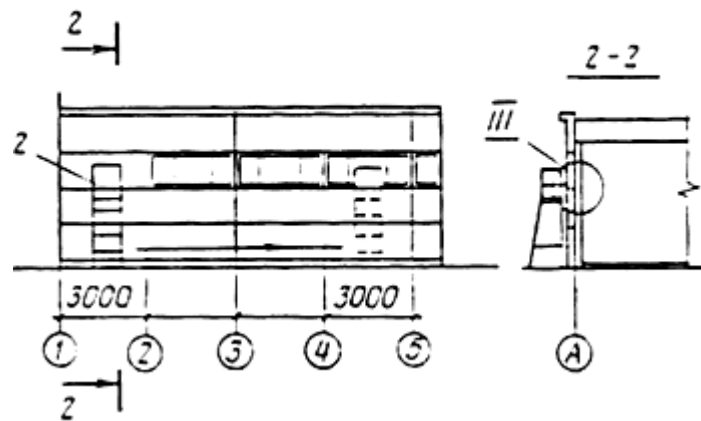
Схема организации строительной прокладки (вариант II), схема заделки стыков
